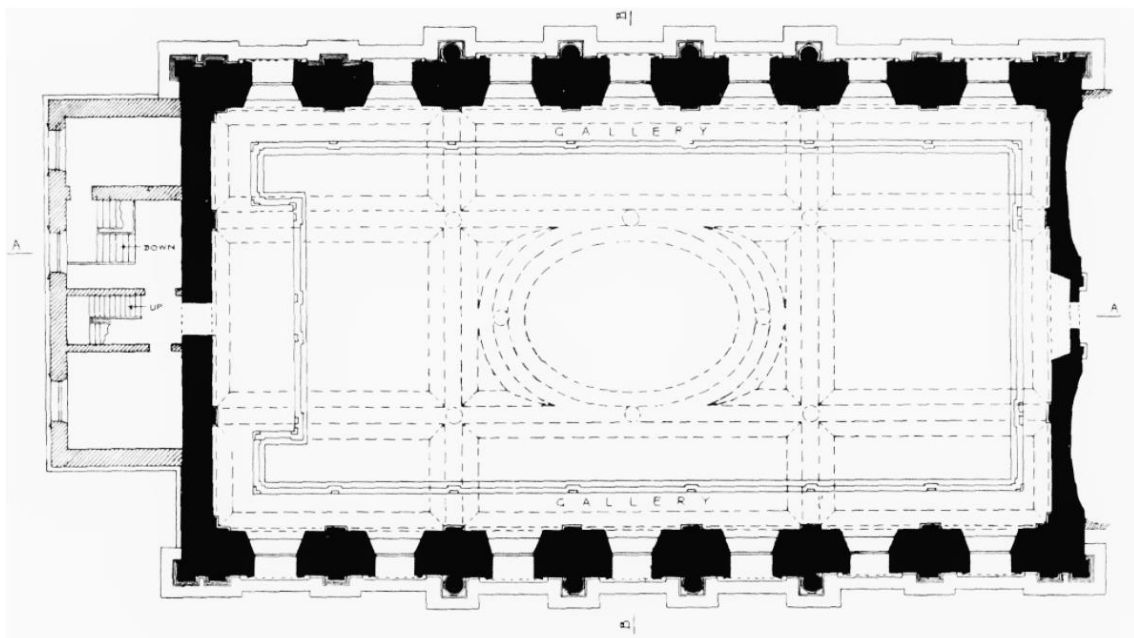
Inigo Jones: *Banqueting House*, Grundriss, Whitehall/London, 1619 – 1622
